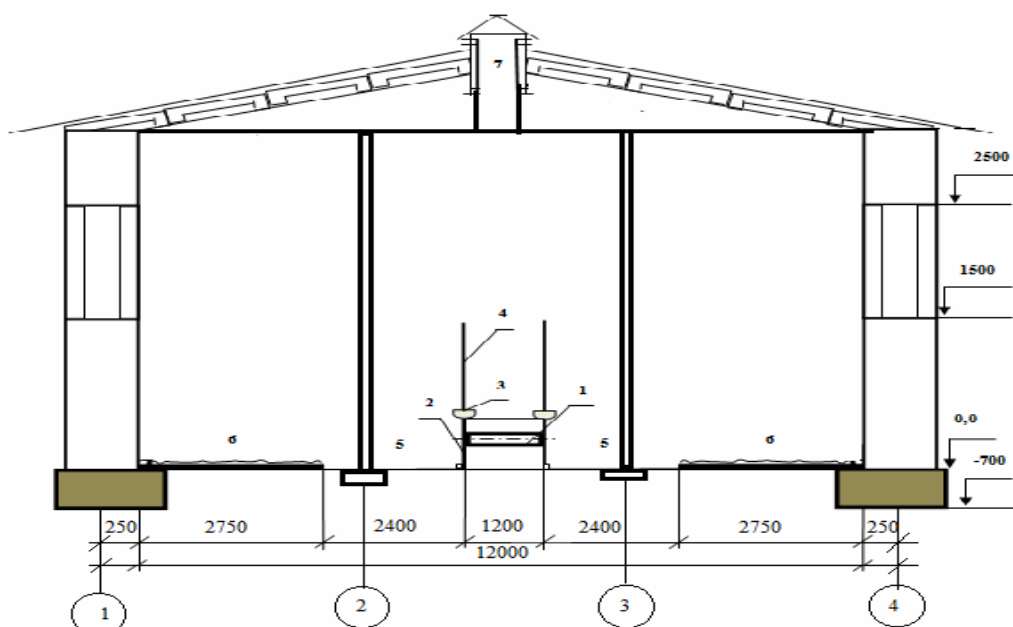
Схема розрізу будівлі 12 × 78 м (4×4×4)
